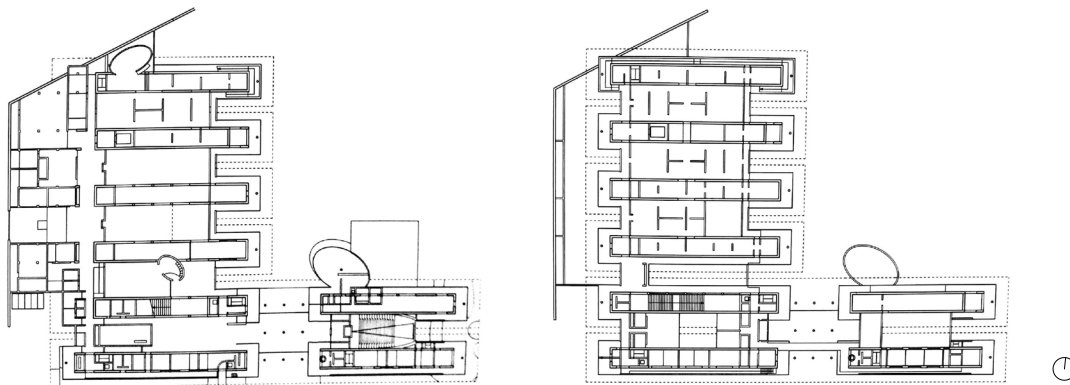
Planta do piso térreo e do primeiro piso do Museu de Arte Moderna, em Fort Worth, projetado por Tadao Ando, de 2002.
